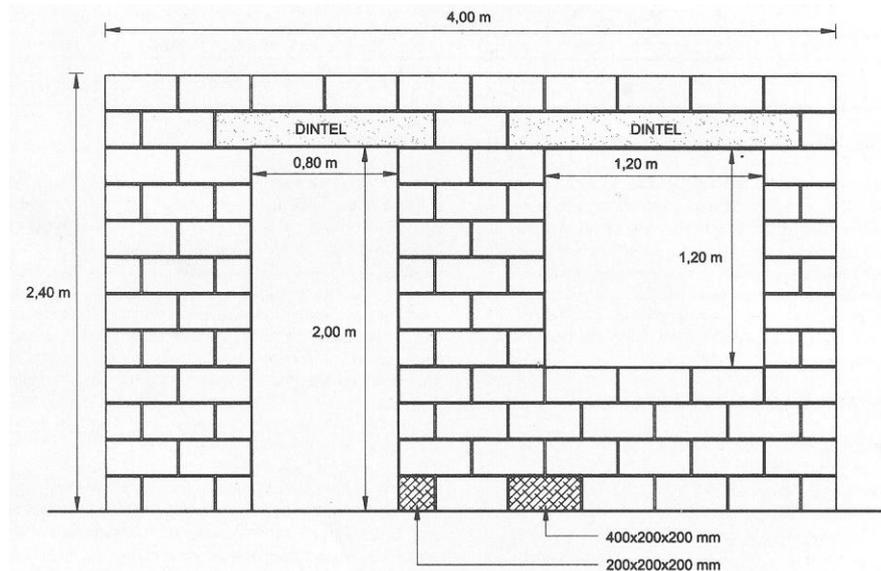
Diseño en espacios libres. Mampostería estructural
